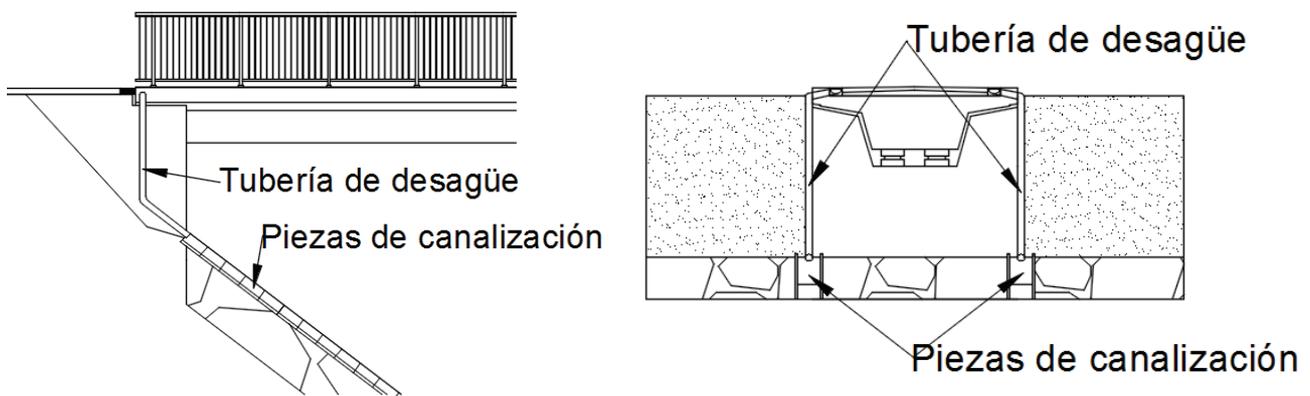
Alzado y Perfil de la zona de apoyo. Detalle de drenaje
